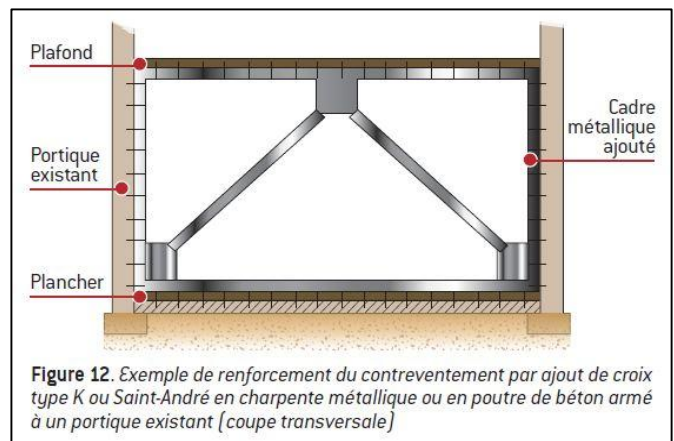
Exemple de renforcement du contreventement par ajout de croix type K ou Saint-André en charpente métallique ou en poutre de béton armé à un portique existant (coupe transversale)
